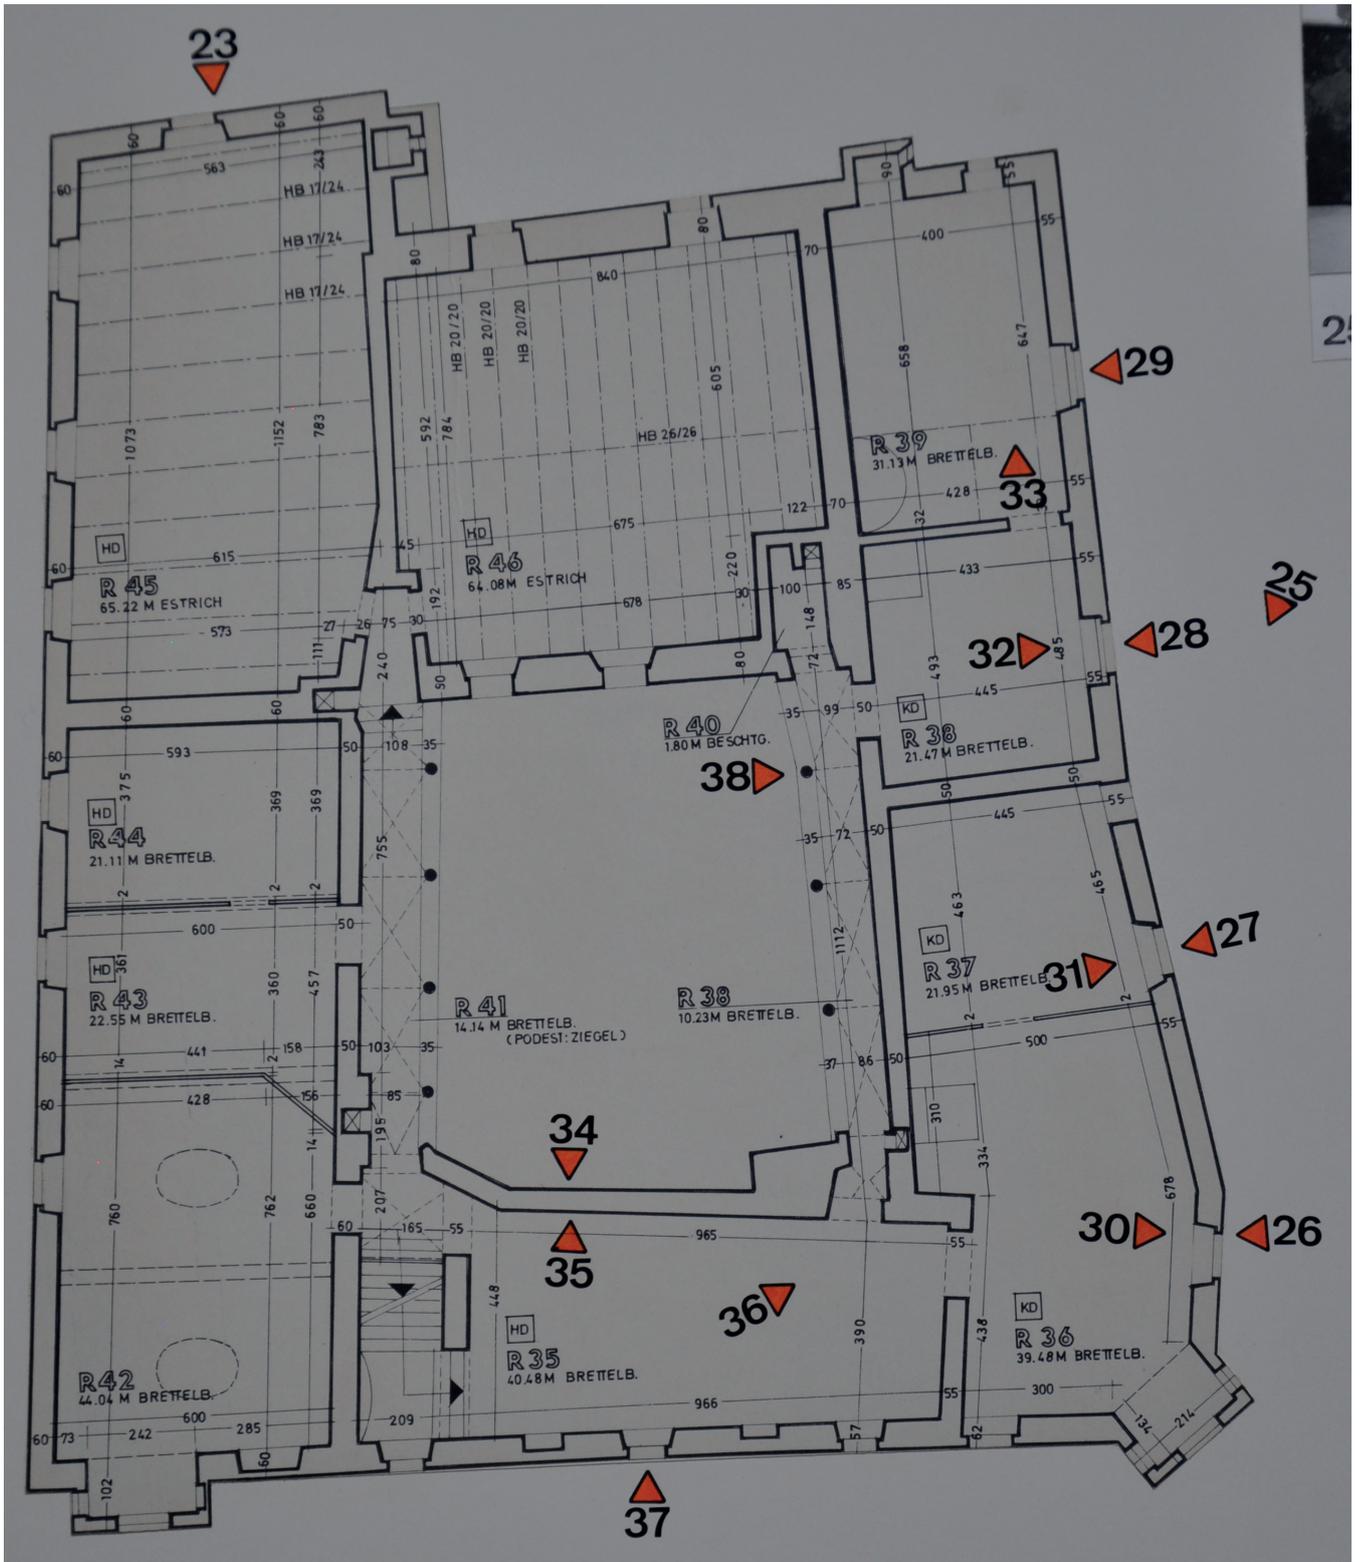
Aufnahmewinkel der Bauschäden am Grundriss des 2. Obergeschosses
